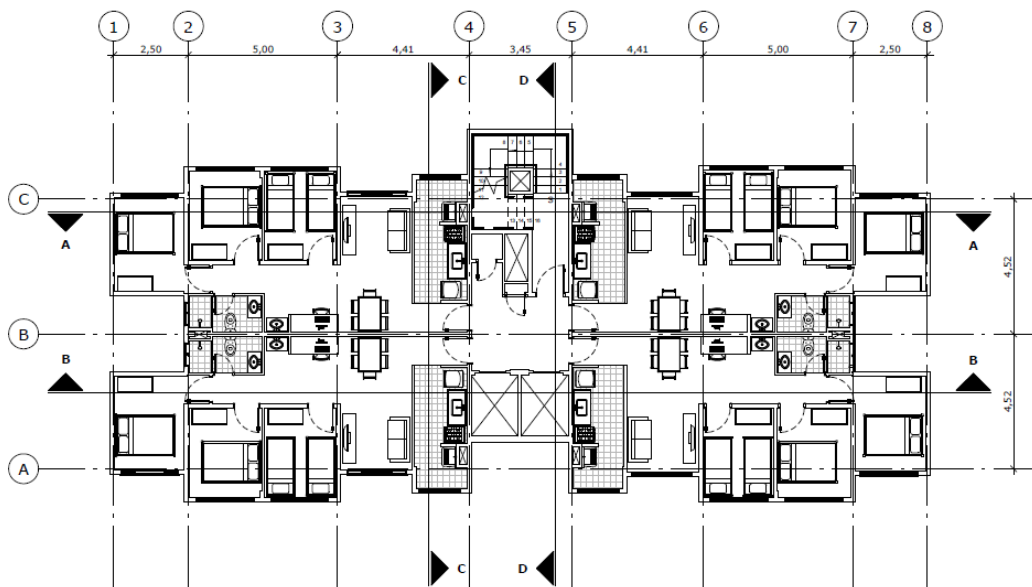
Planta tipo do edifício de 9 andares. Fonte: Levisky e Ferreira (2009)
